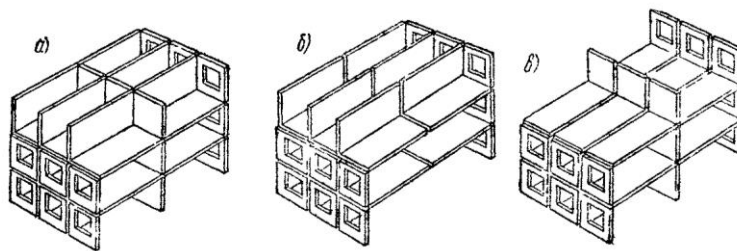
Конструктивные схемы панельных бескаркасных зданий
